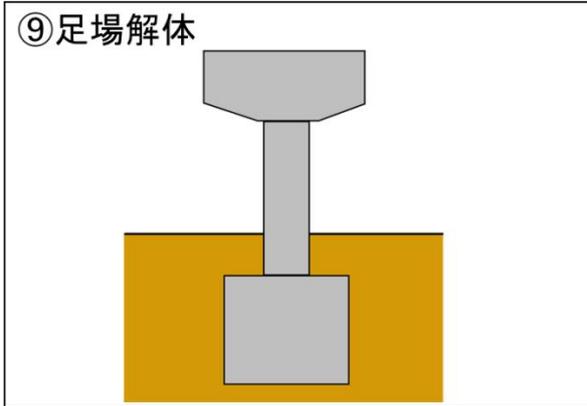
(2) 下部工 (ニューマチックケーソン基礎形式) の施工手順
